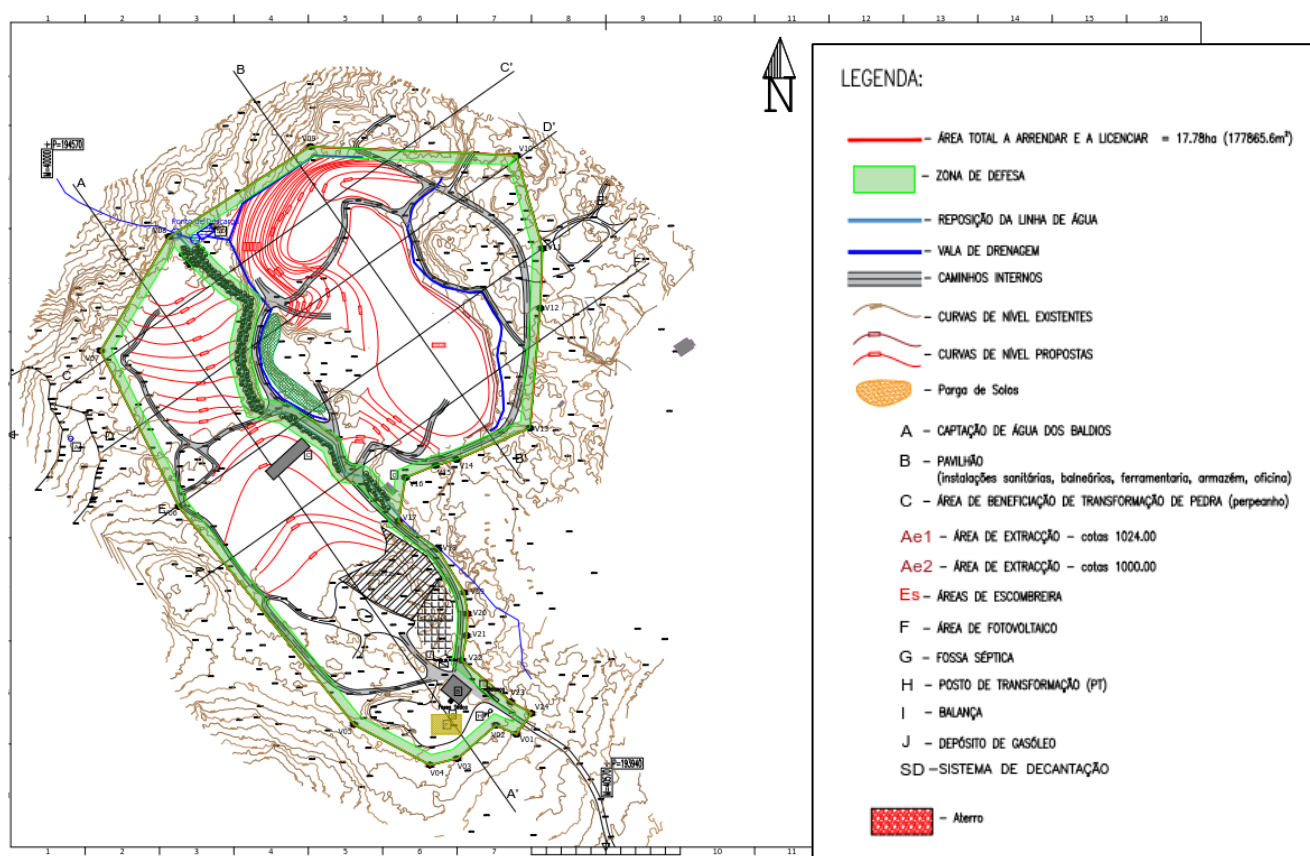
Planta de Modelação – Fase de desativação (ver também plantas em anexo).
